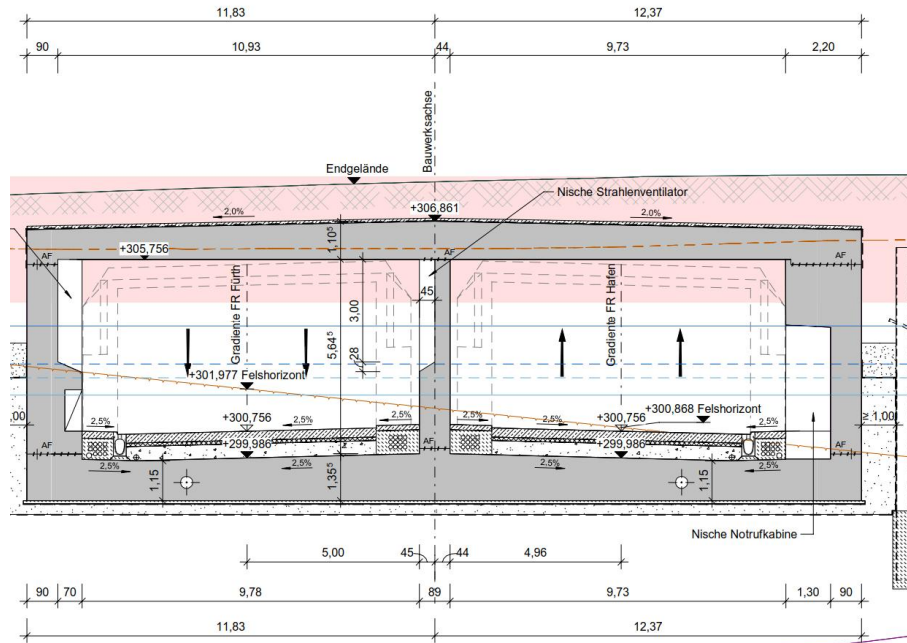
Gewählter Tunnelquerschnitt RQ 31t (durchgehende Strecke)
